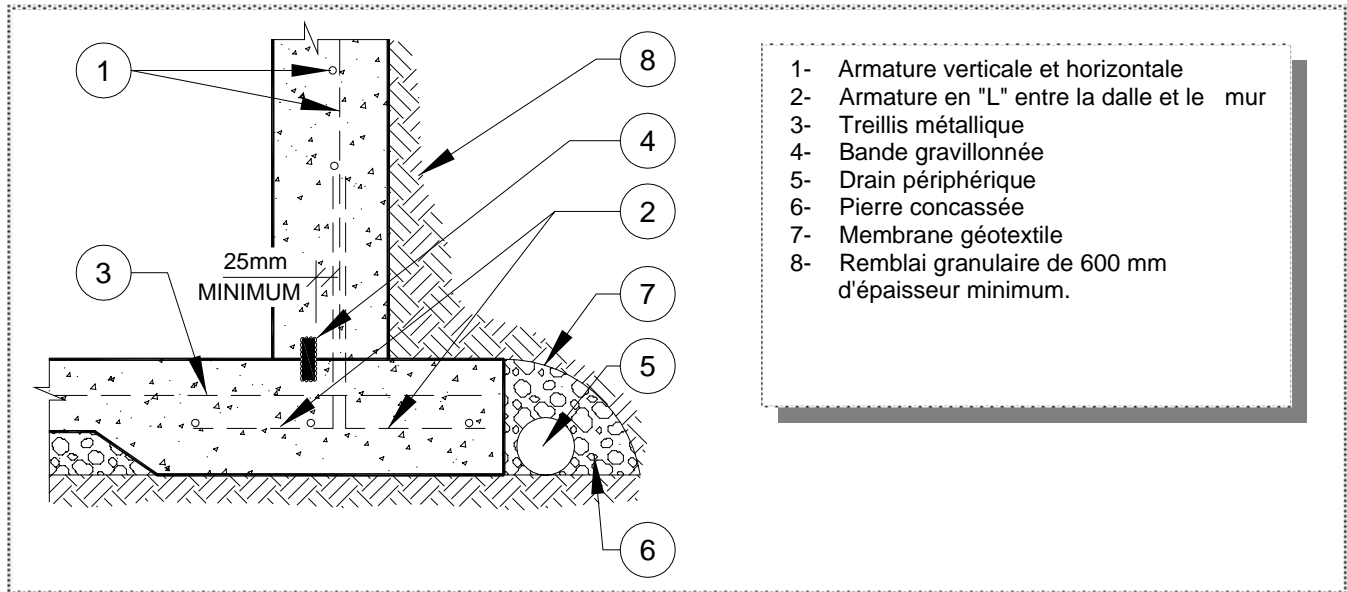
Étanchéité entre la dalle et le mur (Joint de construction)
